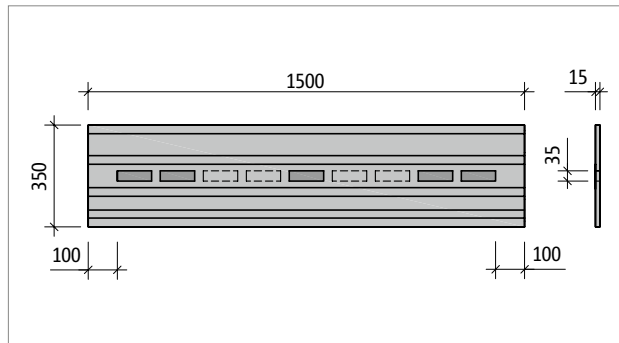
Schöck Tronsole® Typ B-V1...-B350: Produktgrundriss
